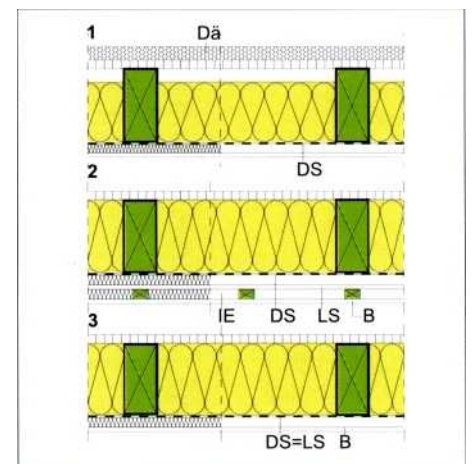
Konstruktionsprinzipien nach DIN 68 800-2 für Decken der Gefährdungskategorie GK 0 unter nicht ausgebauten Dachgeschossen (im Regelfall ist unterseitig eine Dampfsperre (DS) erforderlich)
